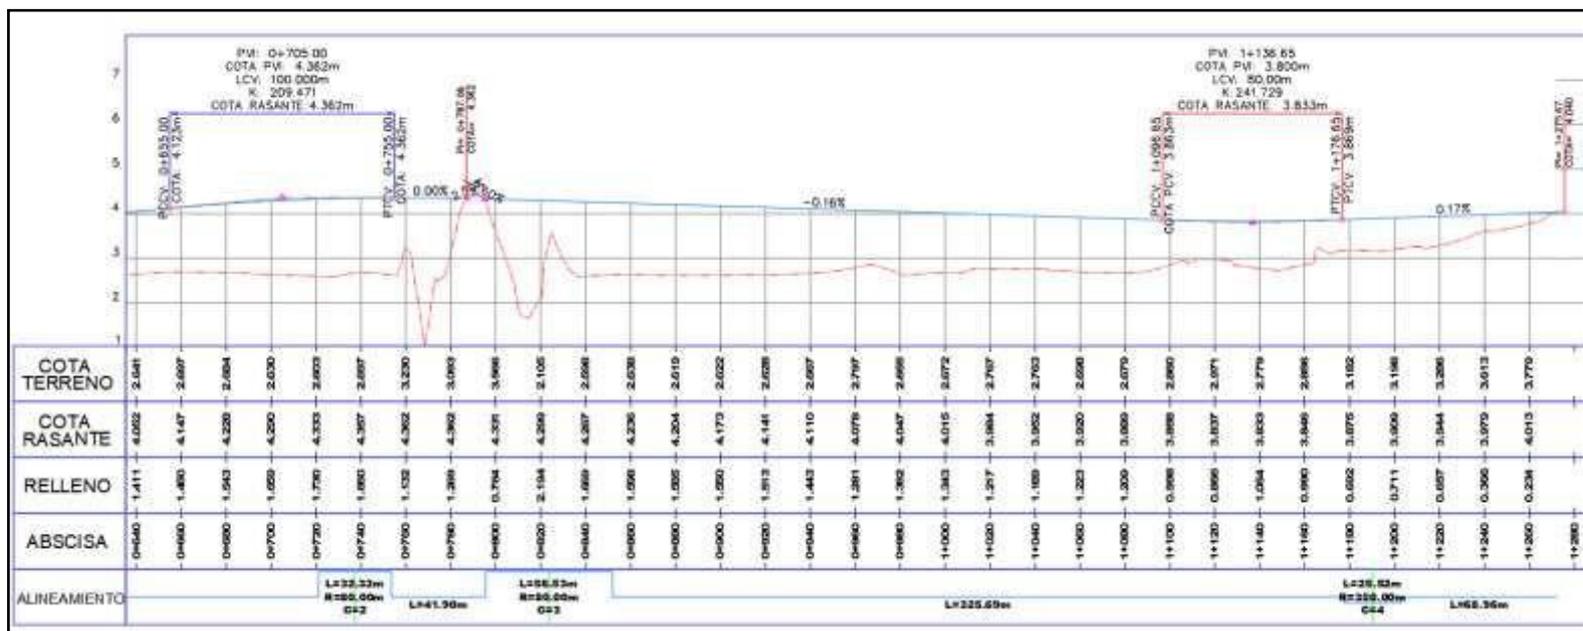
Detalle Perfil Longitudinal (Diseño Vertical) abscisas 0+640 a 1+272.15
